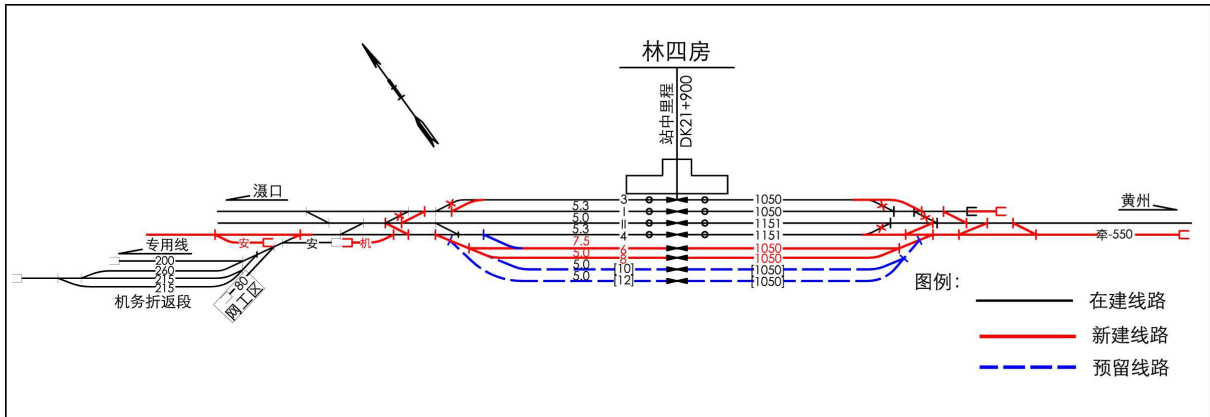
林四房站西咽喉南侧接轨平面布置示意图
